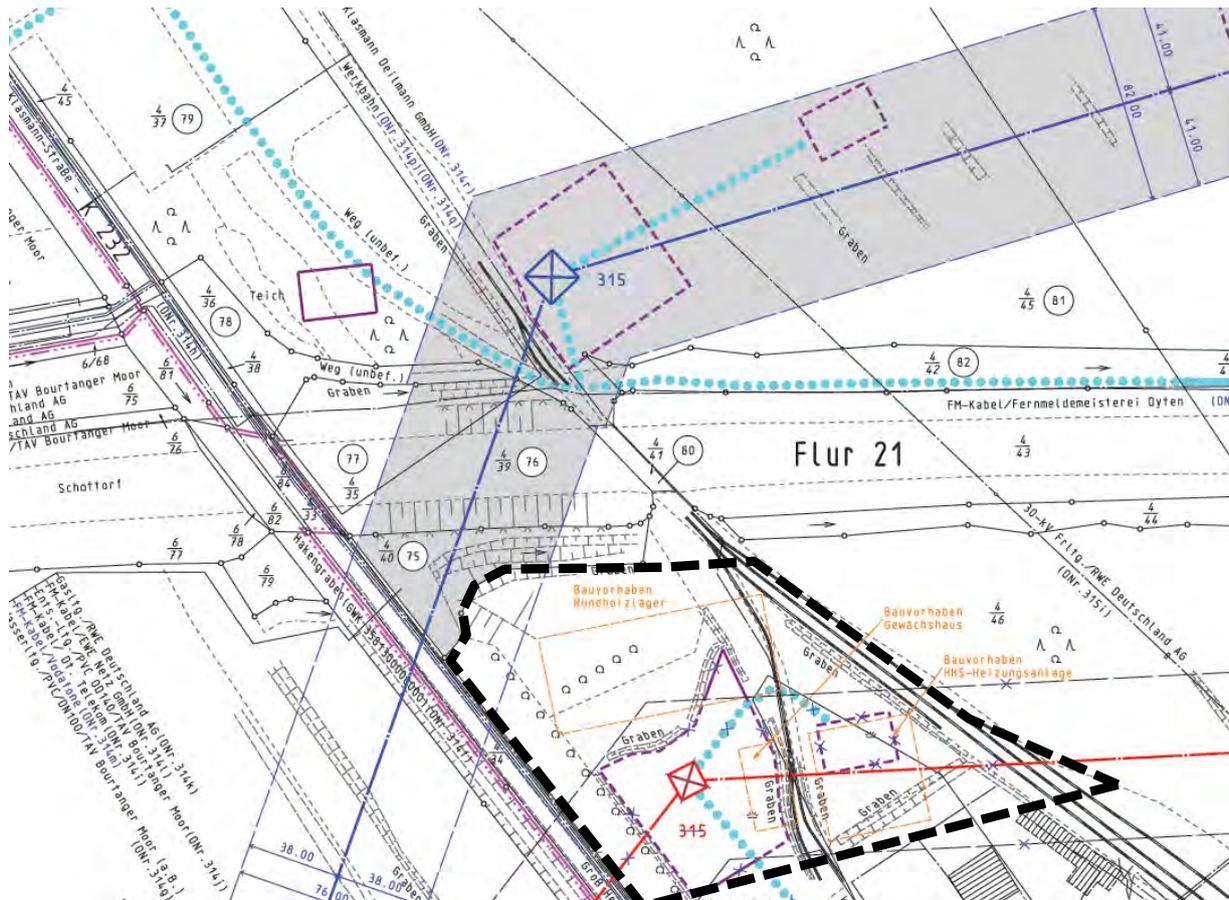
Planfeststellungsverfahren 380-kV-Ltg Wesel-Meppen GA7 Haddorfer See-Meppen DB1 - Ausschnitt aus dem Blatt 1036 „Lageplan 1:2.000 von Mast Nr. 315 bis Mast Nr. 319“ (Amprion GmbH 2021) (blau der geplante Trassenverlauf / rot der ursprünglich vorgesehene Trassenverlauf)
